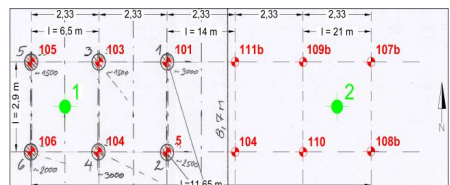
Lageplan Testfeld mit Baugrunderkundungen
